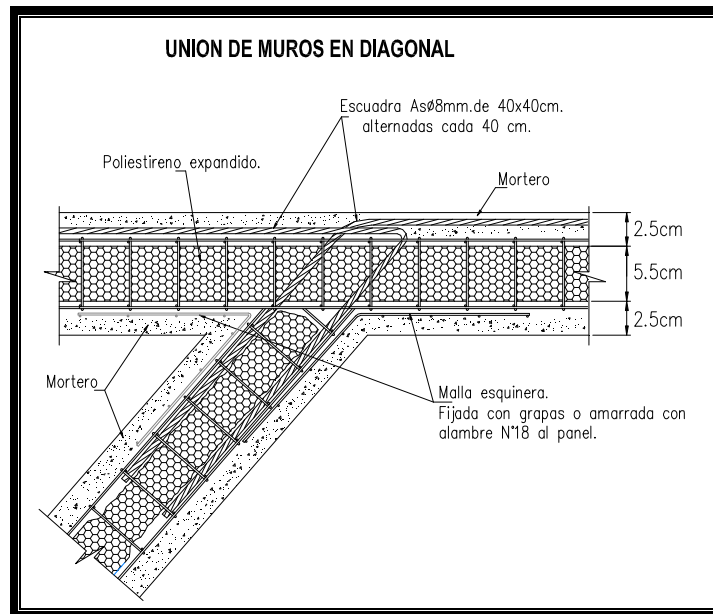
Detalle de armado de acero de refuerzo en muros diagonales
